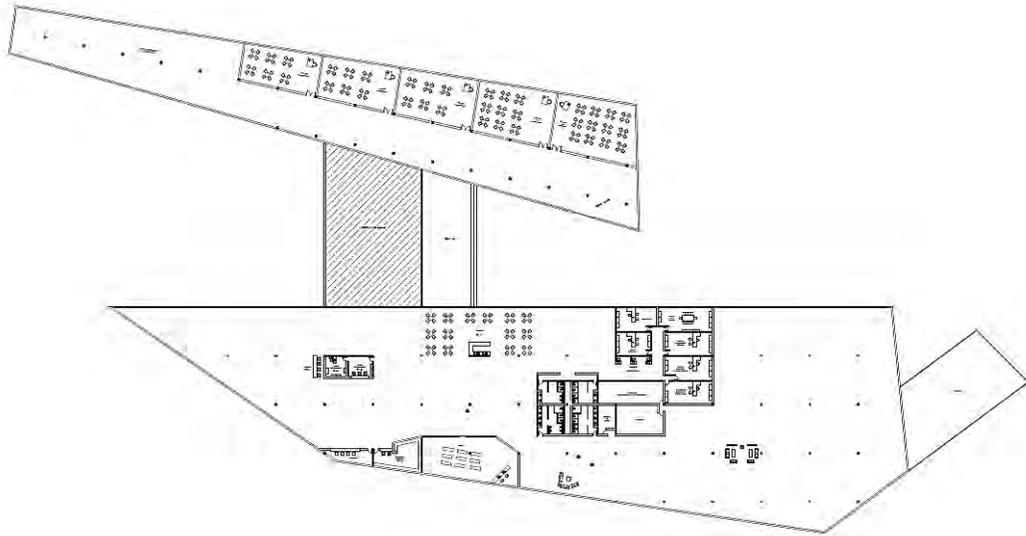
Primera propuesta de la Planta Arquitectónica del Museo.
